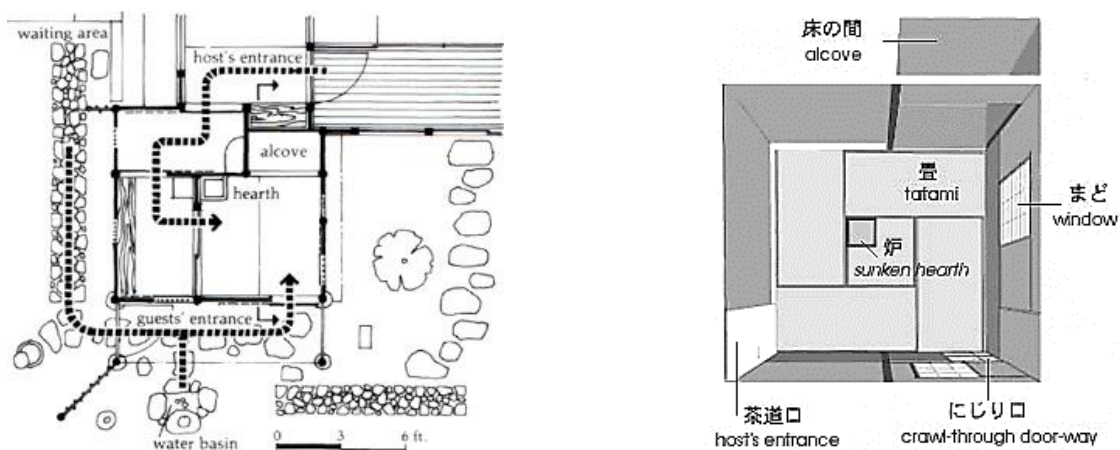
Planta e direções de uma casa de chá japonesa (Remodeling houses ideas, 2011)
